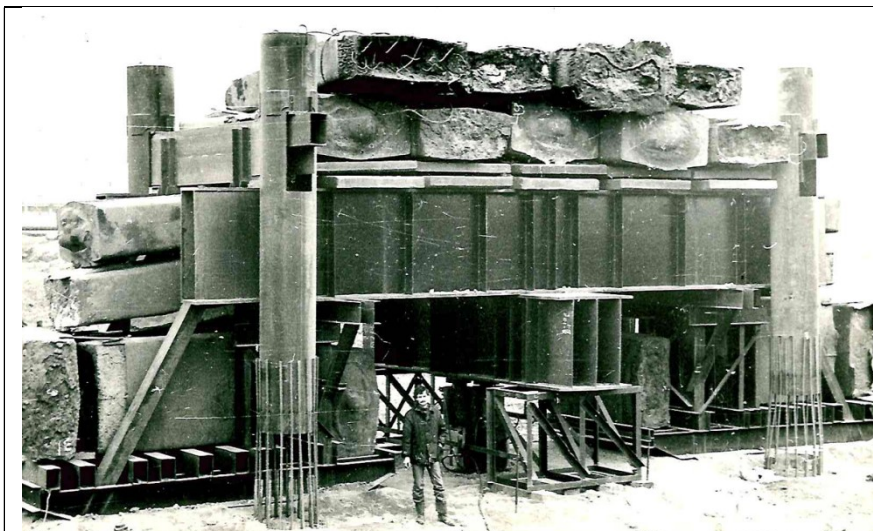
Смонтированный анкерно-упорный стенд с пригрузом для испытаний свай вертикальной вдавливающей нагрузкой
